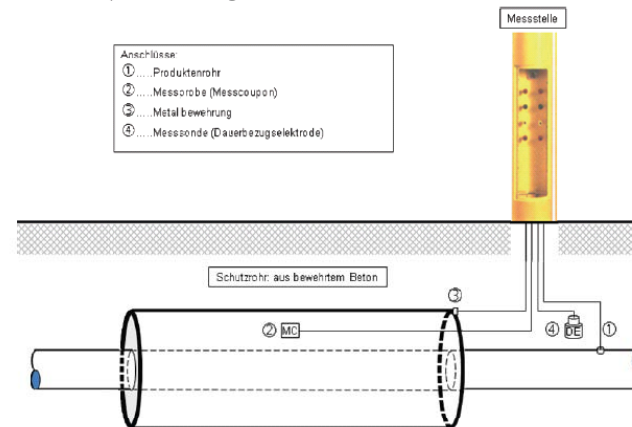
Ausführung einer Messstelle bei Schutzrohr aus bewehrtem Beton
